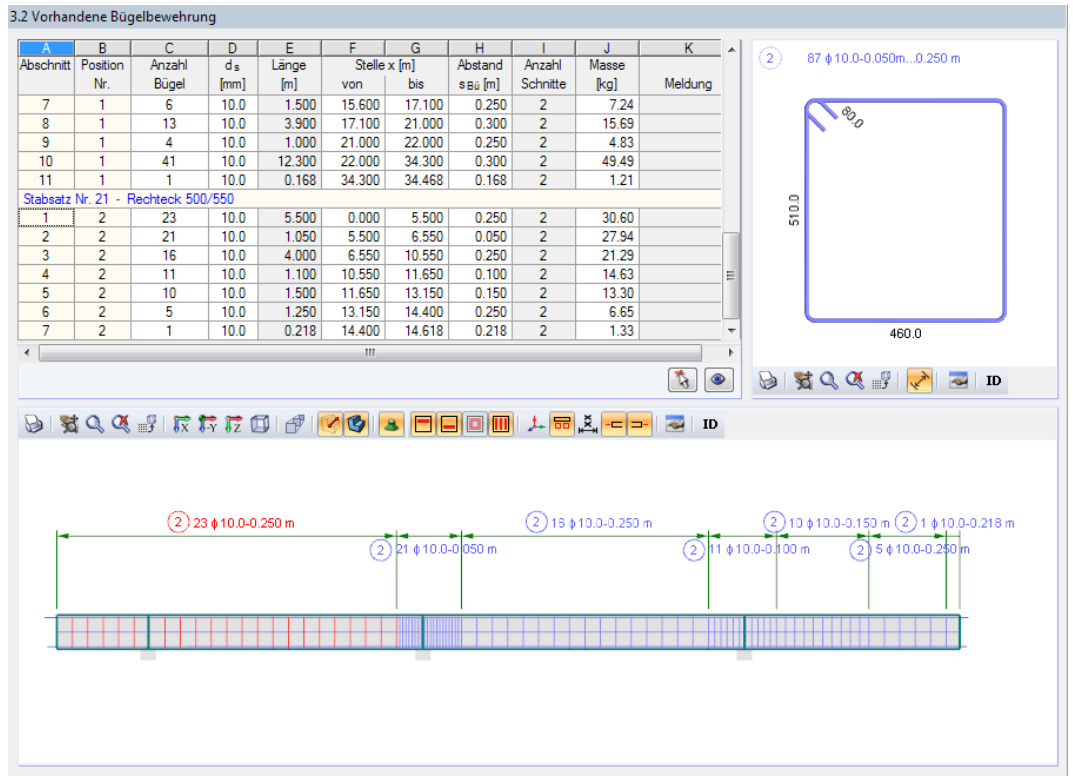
Maske 3.2 Vorhandene Bügelbewehrung
